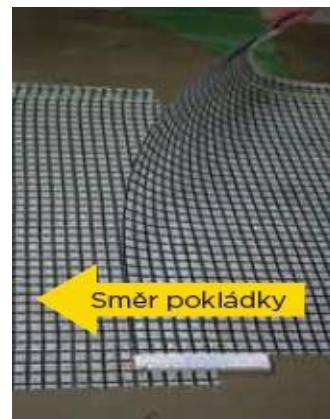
Instalace geomříže – ručně, zdroj [14]
